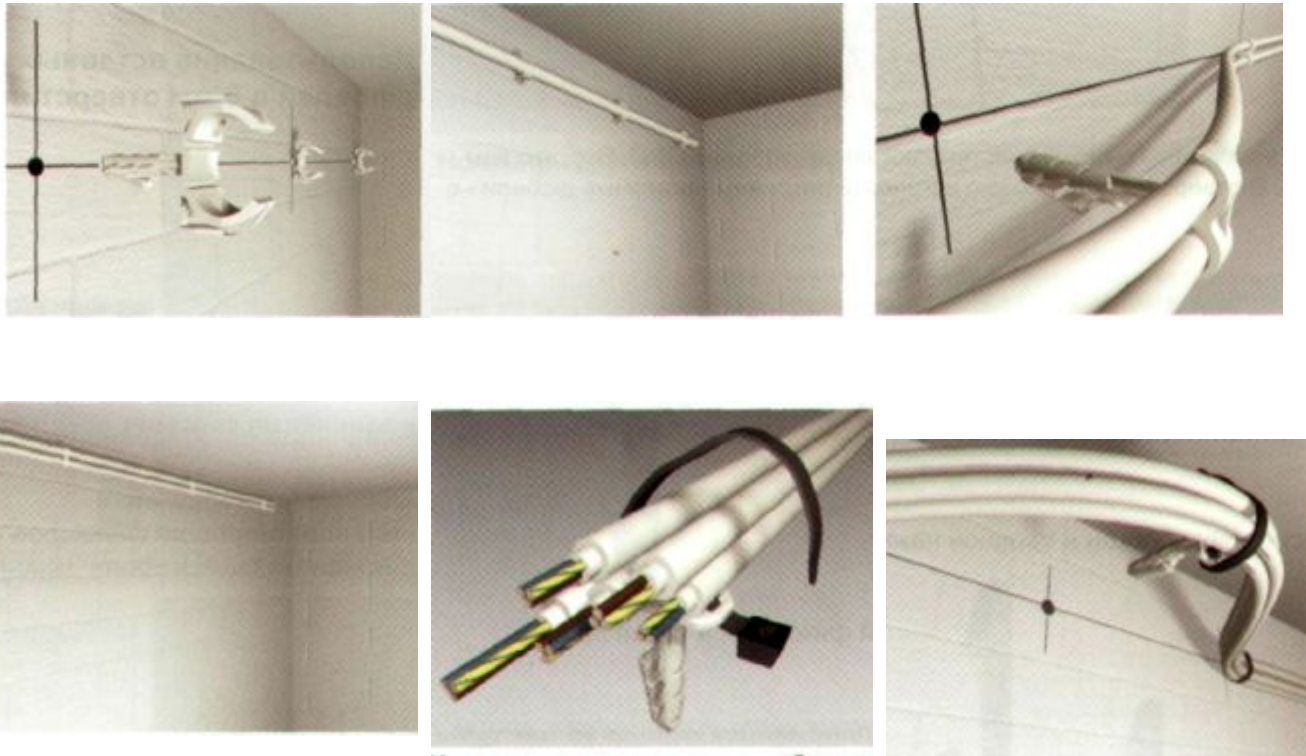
Фрагменты монтажа открытой электропроводки
